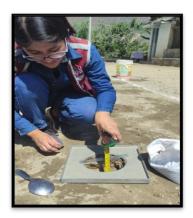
El suelo obtenido se coloca en una bolsa plástica para mantener su humedad, para que posteriormente sea llevado al laboratorio y se determina su contenido de humedad
